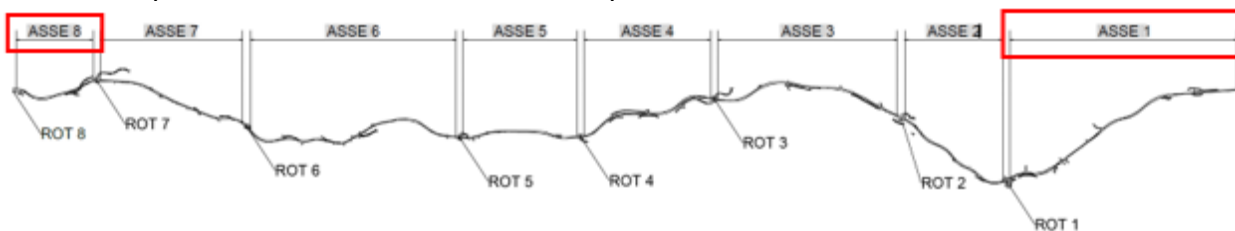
FASE 1 DI CANTIERIZZAZIONE
